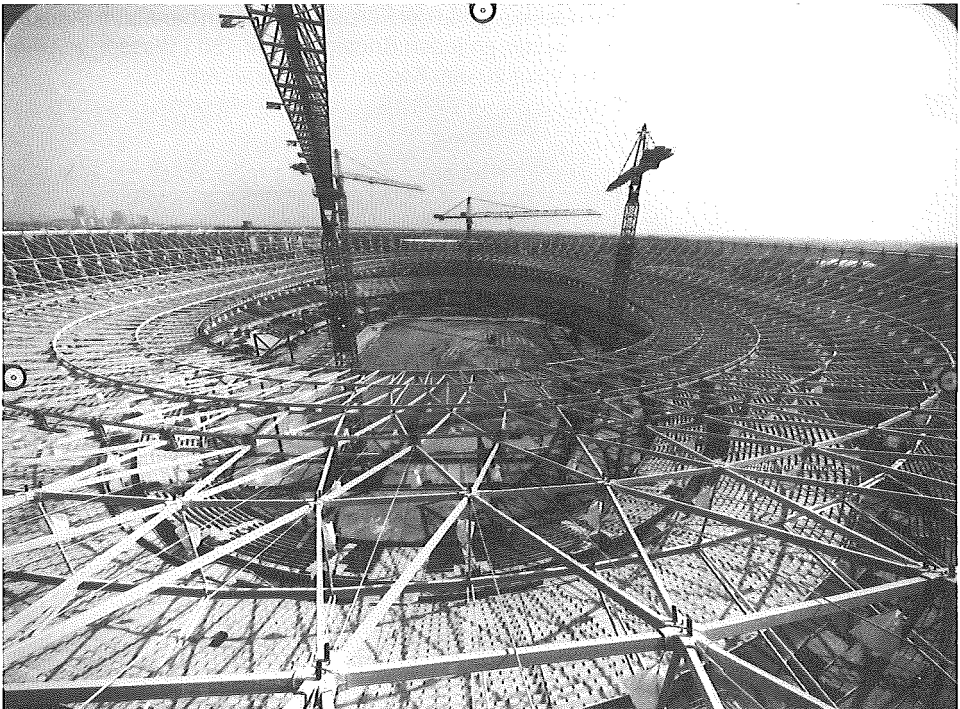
Übersichtsaufnahme der Dachkonstruktion
